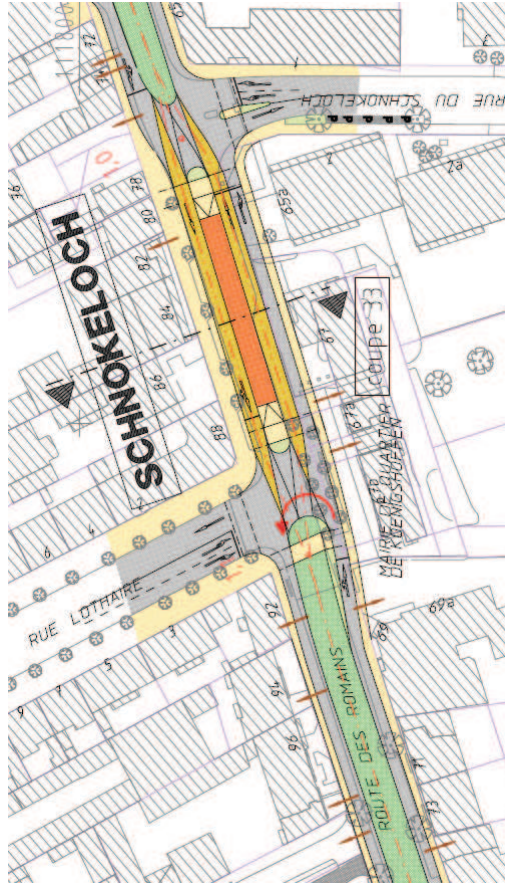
plan zoom station "Schnockeloch" en site mixte
